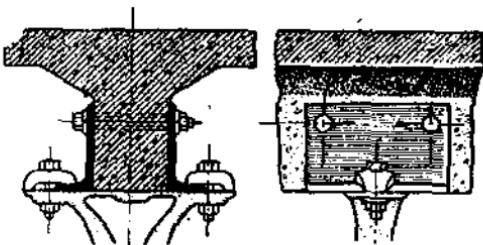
Укрепление подвески на бетонной балке поперек балки с помощью балок из углового железа.
